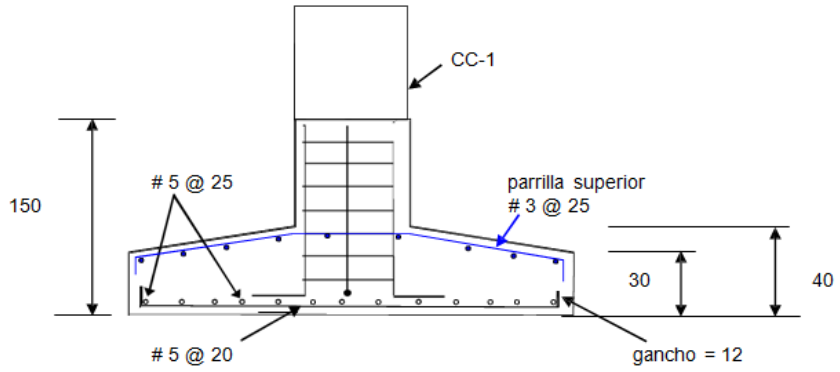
Dimensiones en corte de zapata Z-7.
